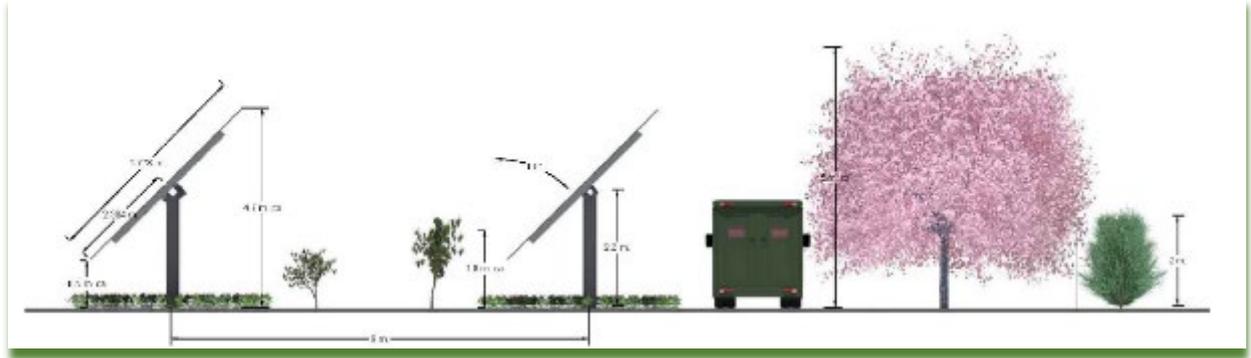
Sezione laterale dell'impianto con disposizione delle linee vegetali
